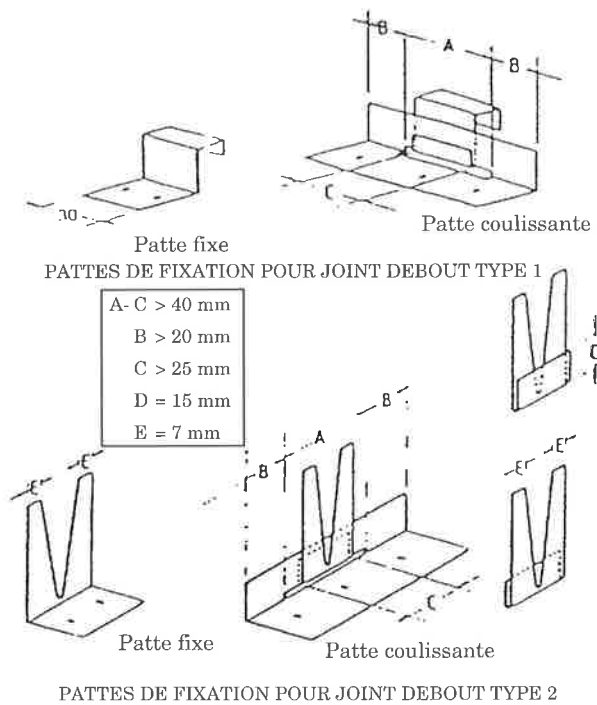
Pattes coulissantes pour couverture en acier inoxydable
